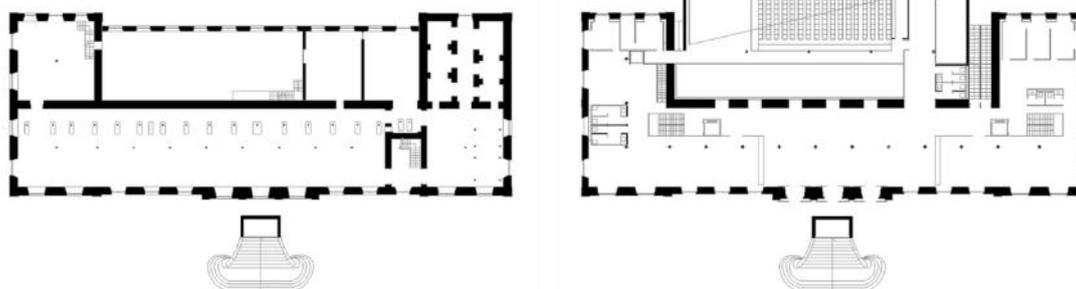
Planta baja. Edificio original / Edificio Rehabilitado.
